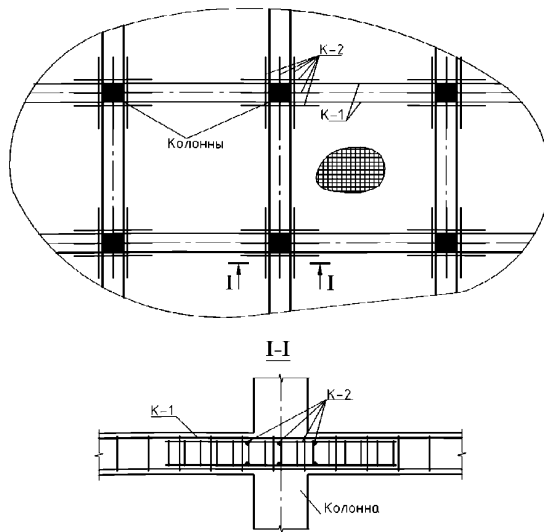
Пример усиления армирования плиты плоского (безбалочного) перекрытия каркасами: К-1 – пролетный каркас, К-2 – надпорный каркас
